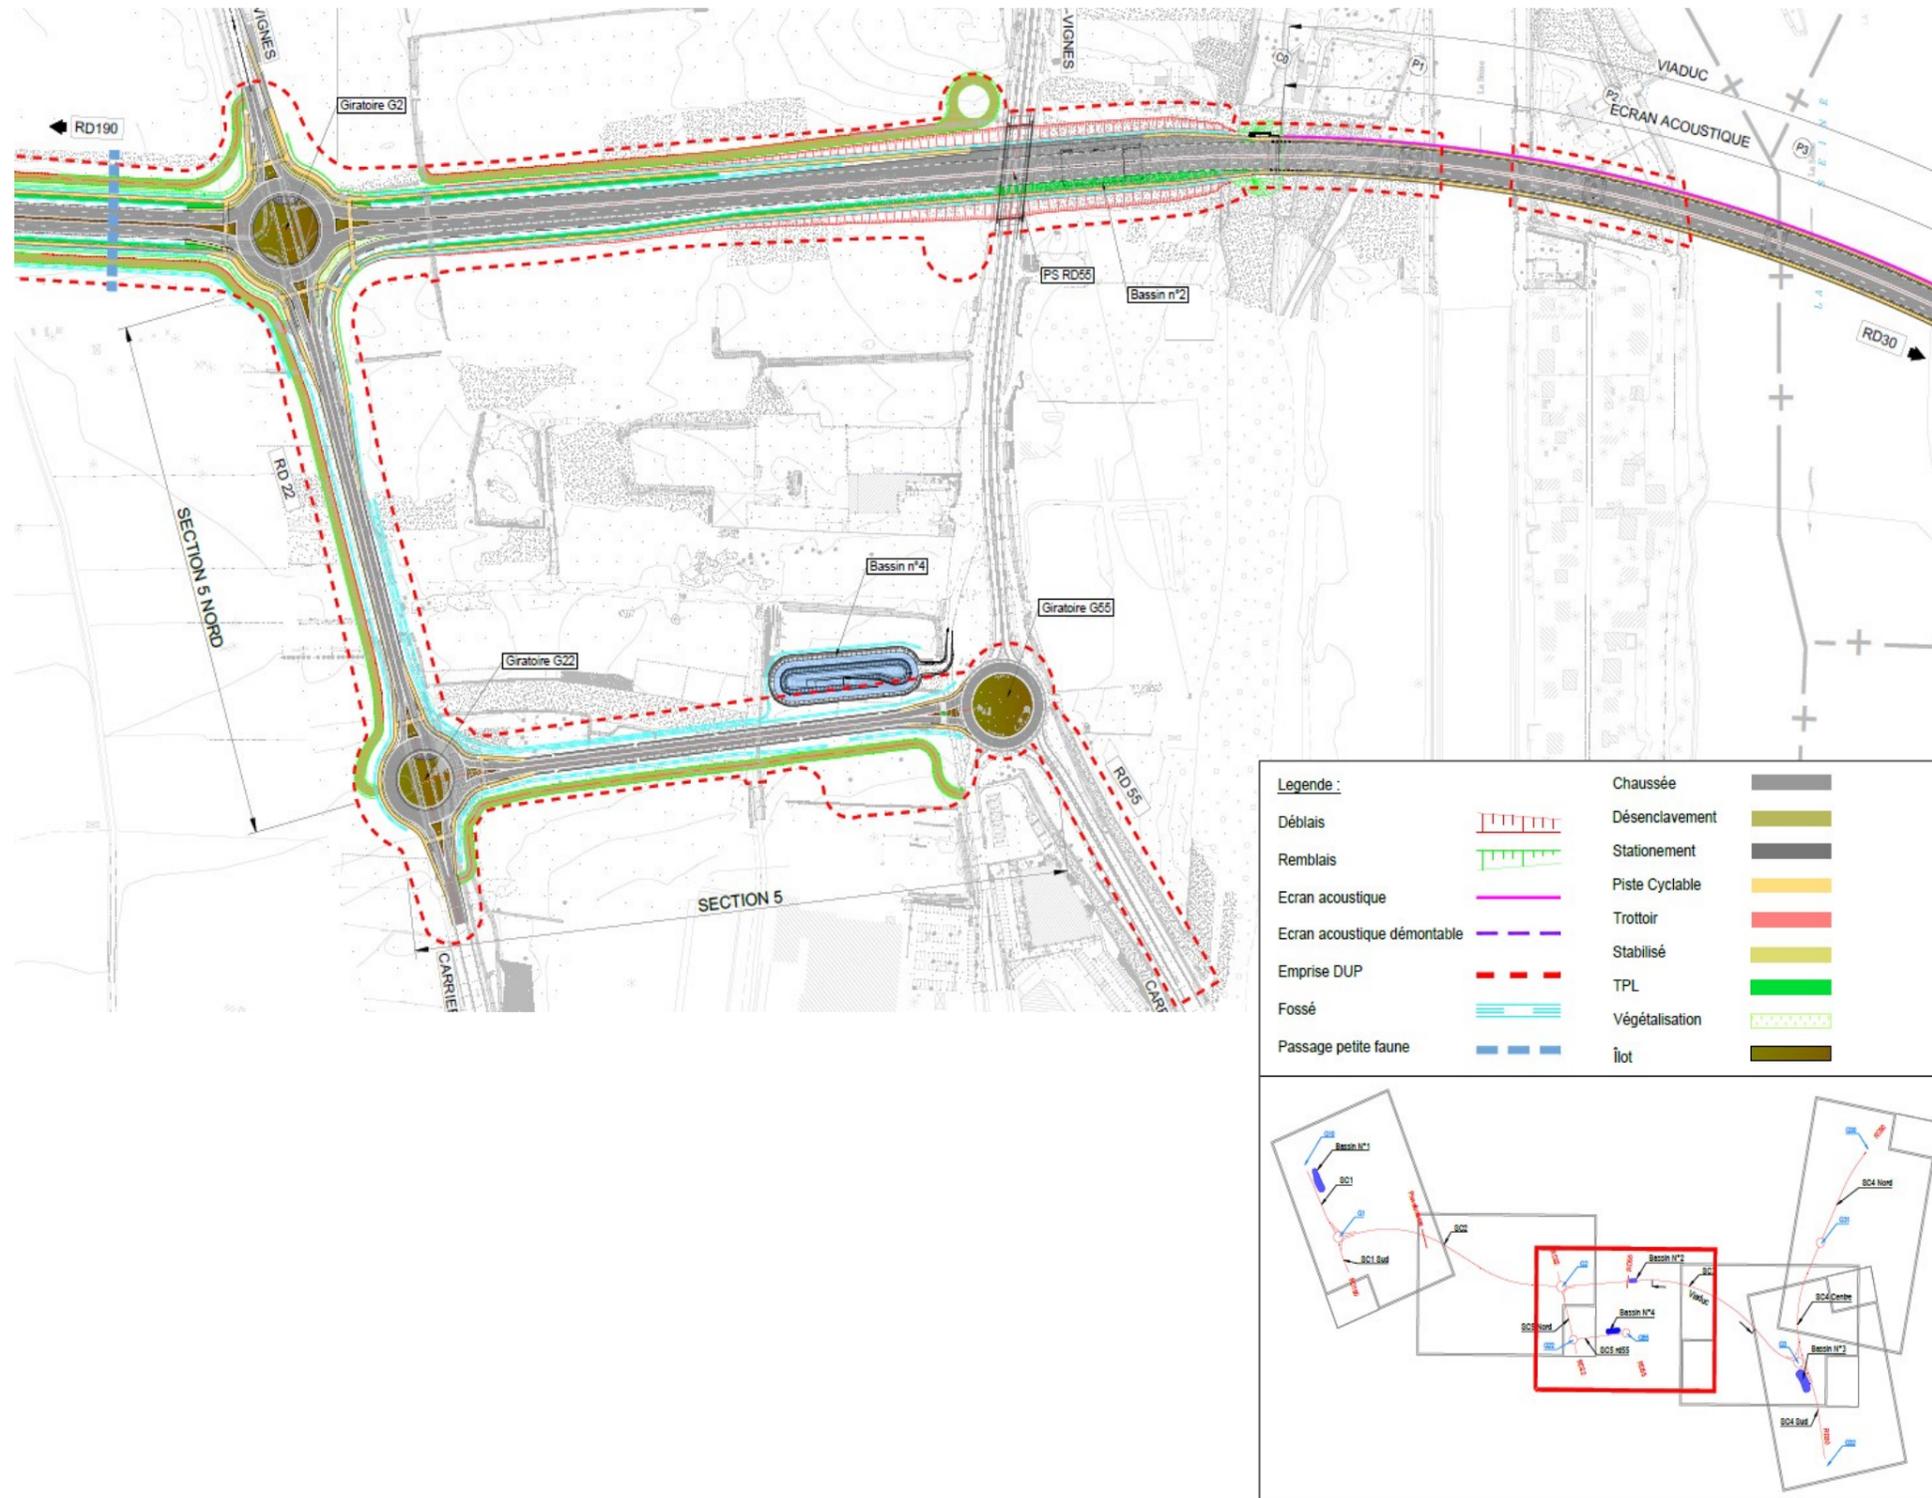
Vue en plan du projet au droit de l'île de la Dérivation et du boisement des Garennes (source : Ingerop)
